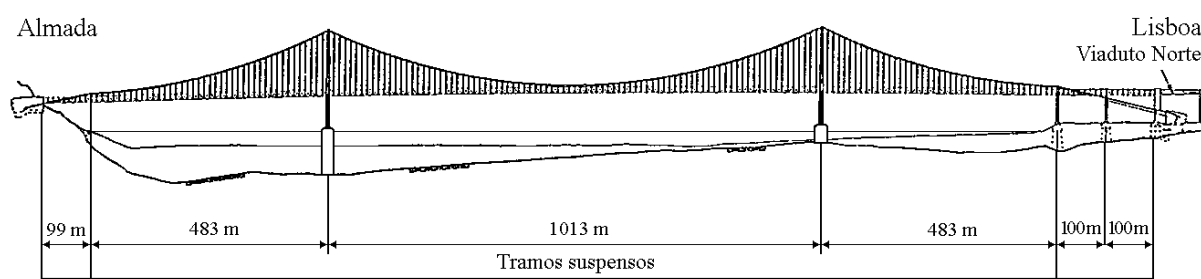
Corte longitudinal da ponte suspensa sobre o rio Tejo.
